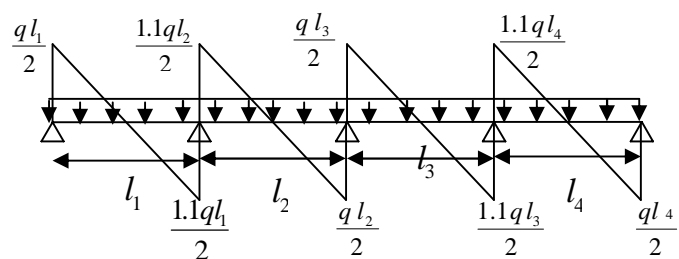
Effort tranchant d'une poutre à plus de 2
